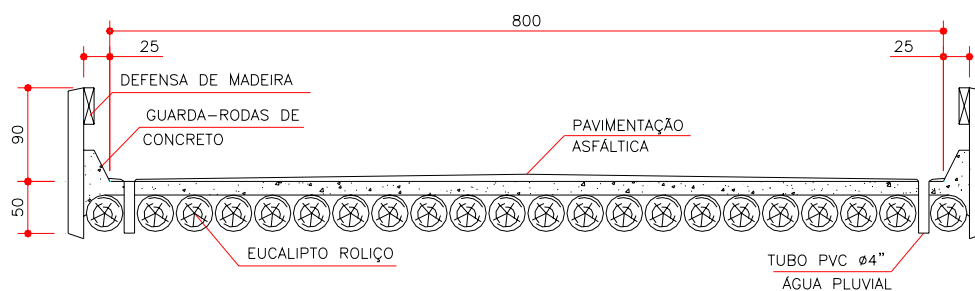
Seção transversal da ponte em placa mista de madeira-concreto com duas faixas de tráfego
